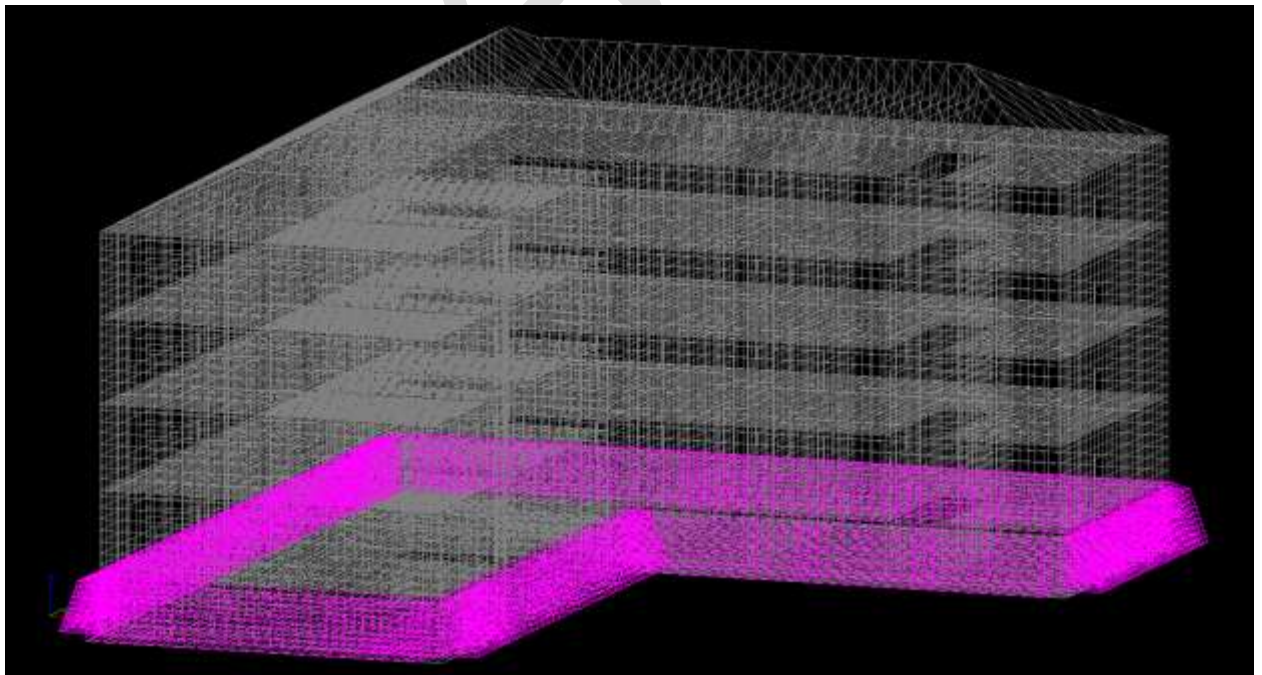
Расчетная схема жилого здания с нагрузкой от грунта в SCAD
